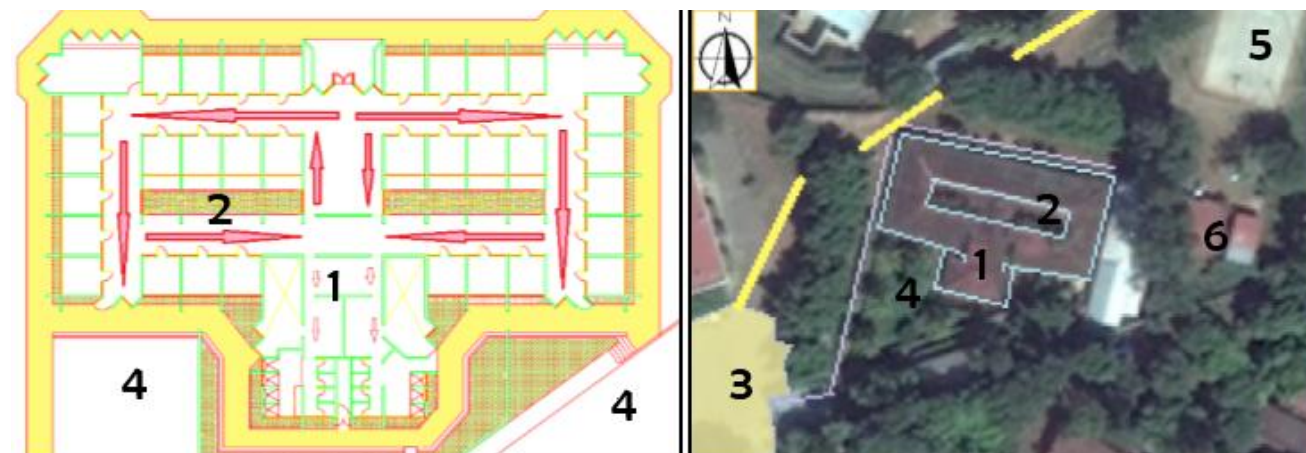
Planta arquitectónica de la Residencia estudiantil.
